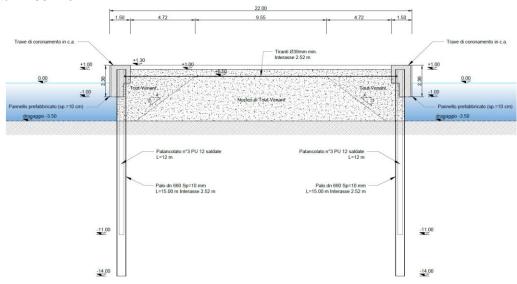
Sezione Trasversale del 1° Sporgente
